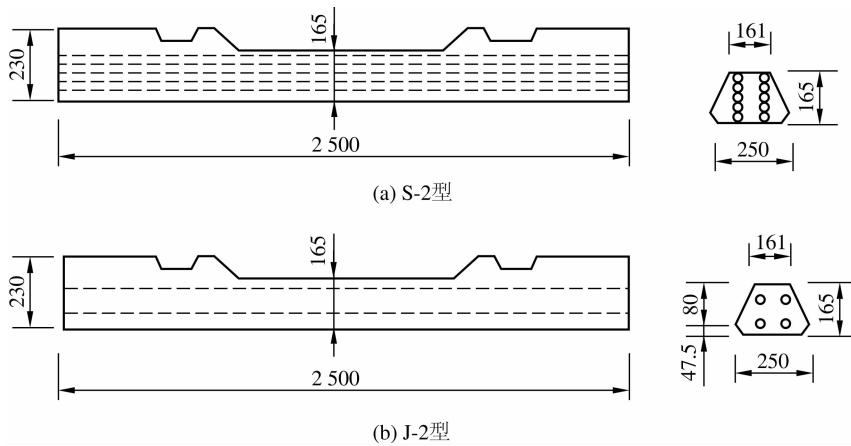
Ⅱ型混凝土枕的外形尺寸及配筋(单位: mm)
